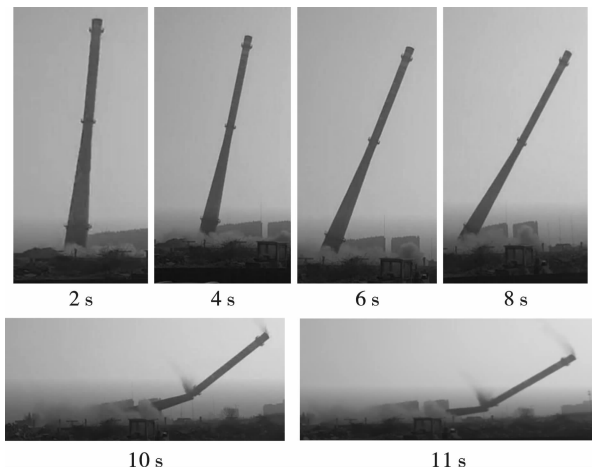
钢筋混凝土排气塔爆破拆除倒塌过程
